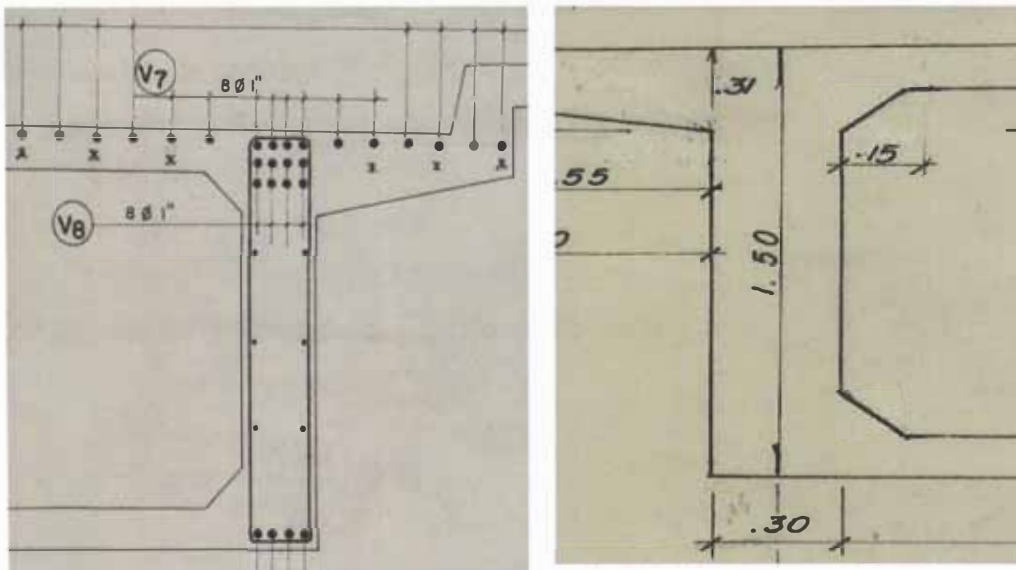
Vista de la sección de viga exterior con refuerzo para el momento negativo.
